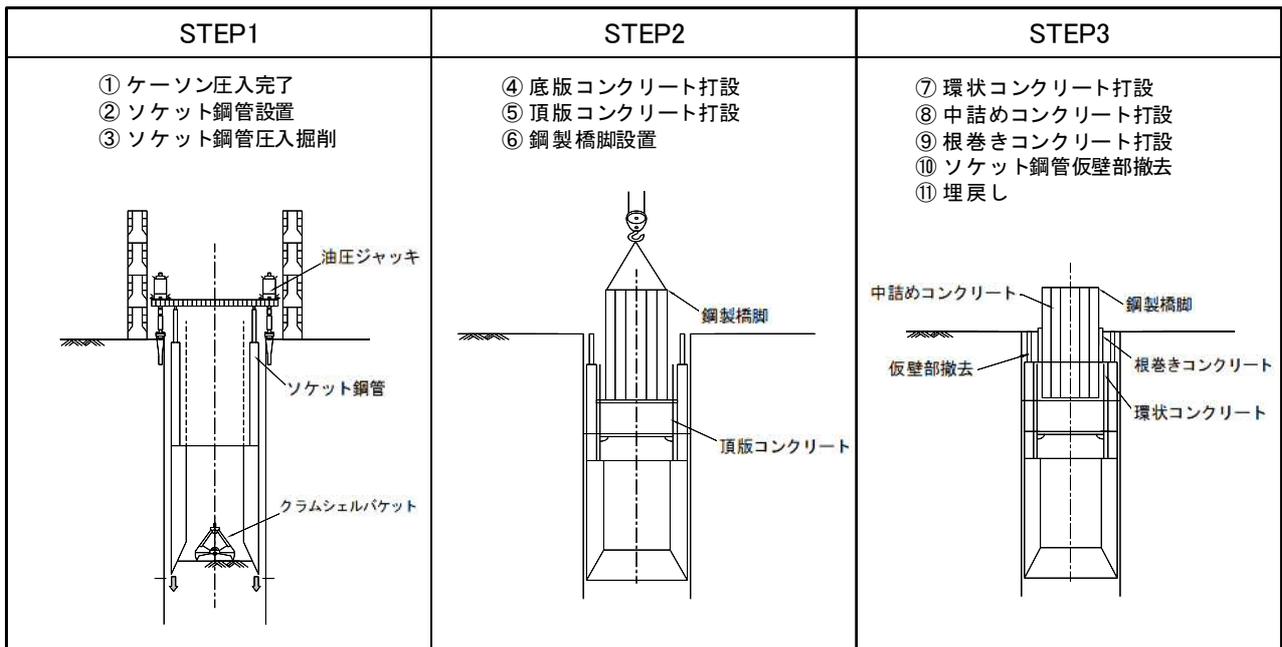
鋼管ソケット接合形式橋脚の施工ステップ概要
